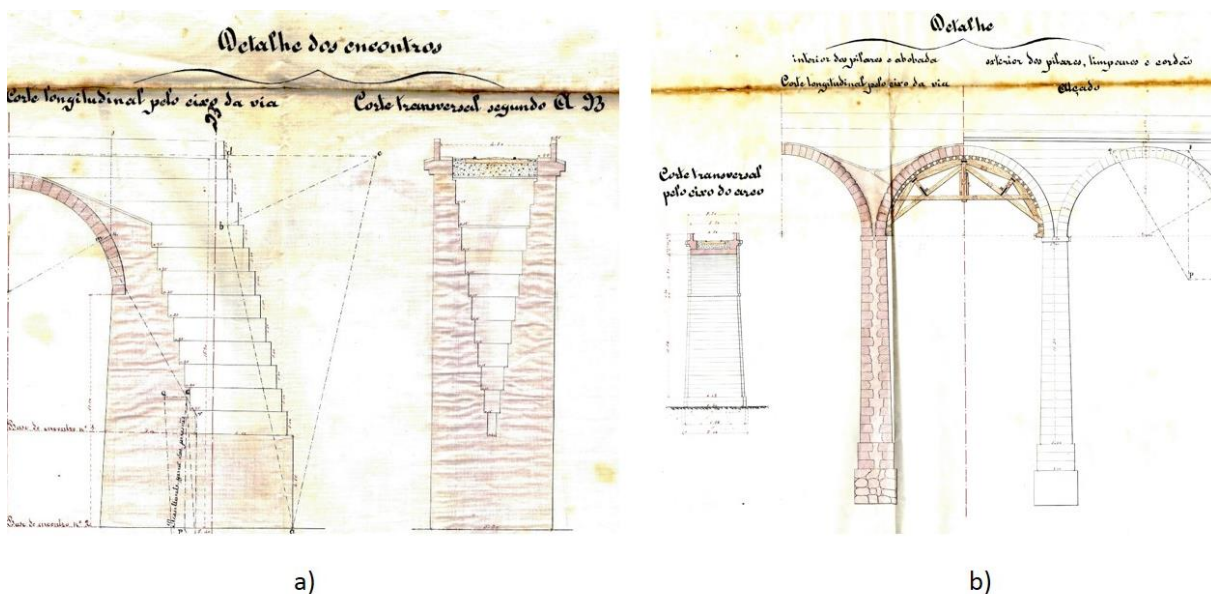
a) Desenho do projeto da ponte de Durrães com o detalhe da forma do enchimento; b) desenho que representa o interior dos pilares, espessura do arco e separação entre zonas de enchimento.
